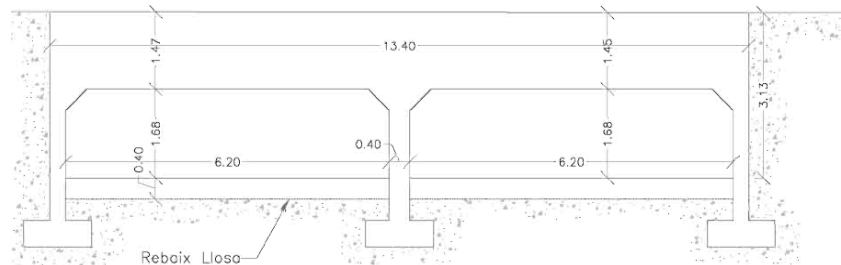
Solució constructiva proposada en l'estudi hidràulic.
